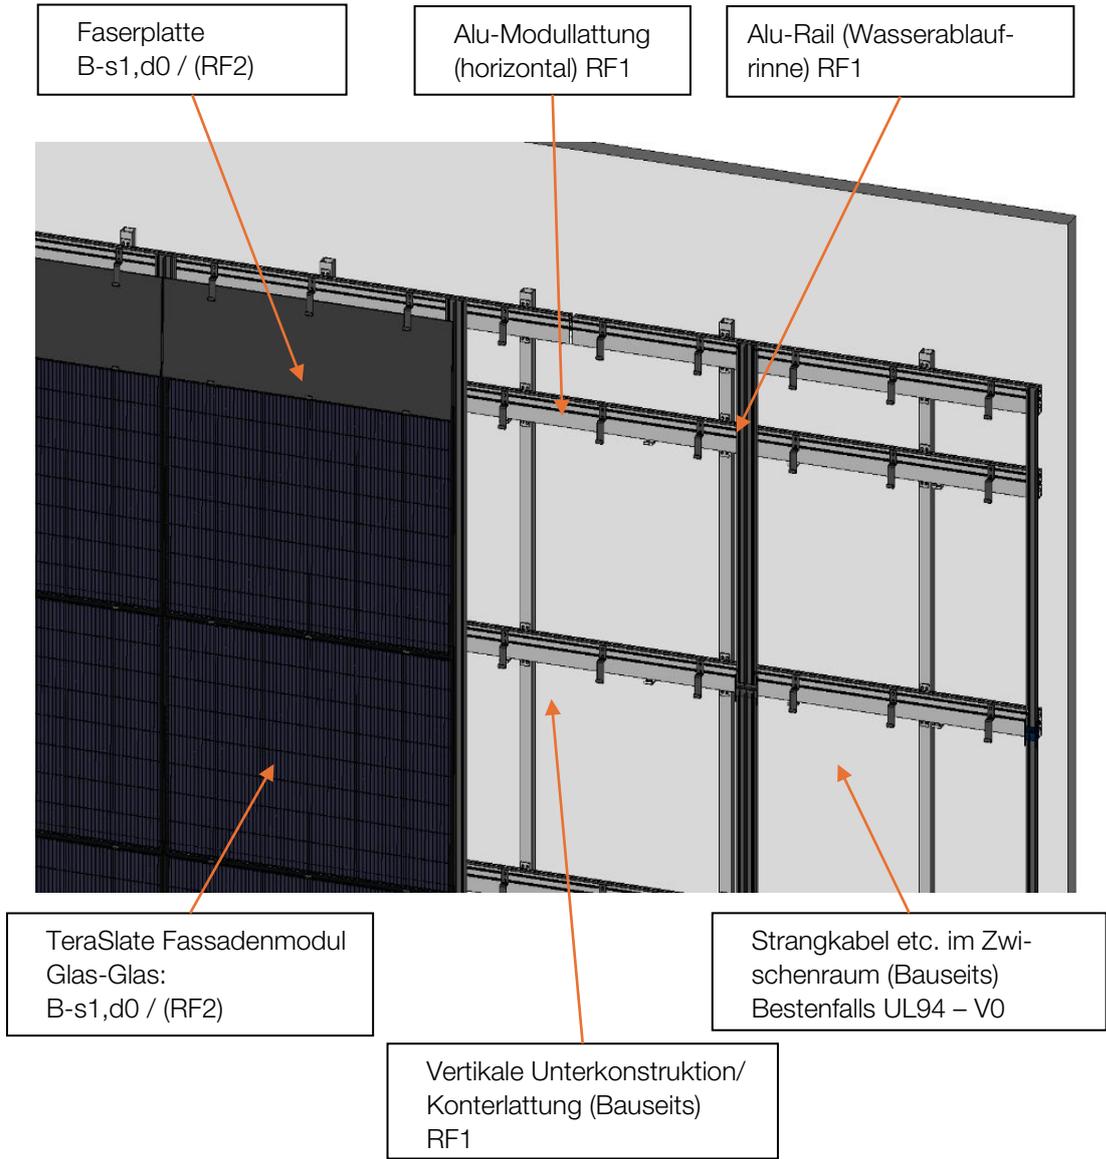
Brandverhalten der Elemente der 3S Solarfassade mit Alu-Unterkonstruktion
